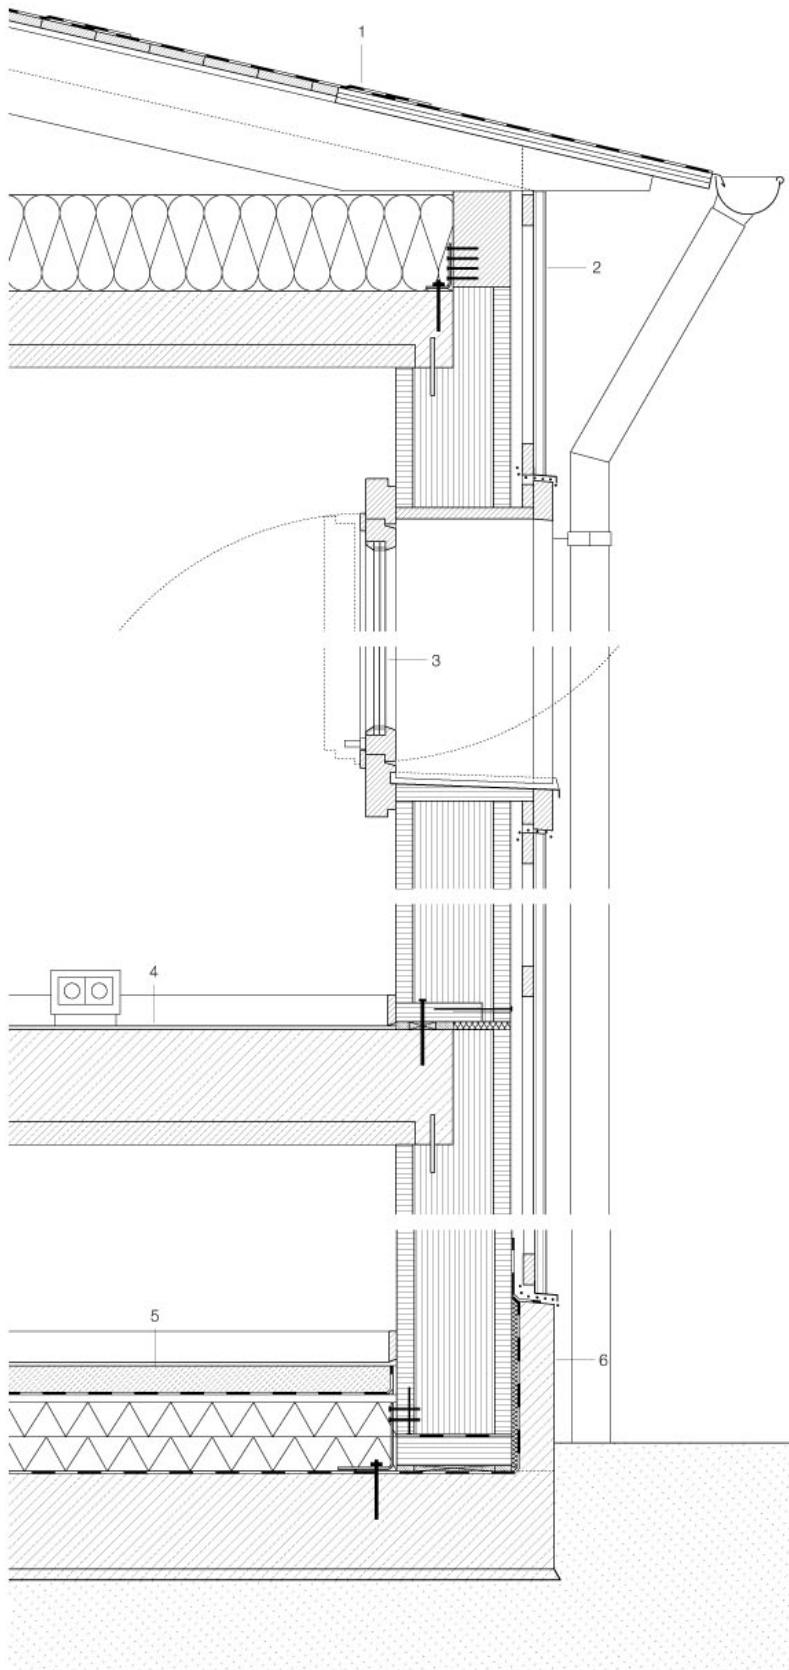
Fassadenschnitt Gebäude Holz massiv:
